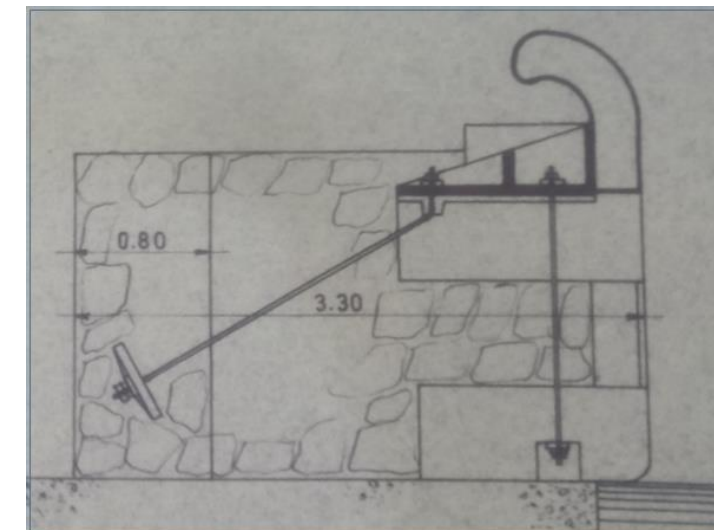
Detalle constructivo de empotramiento de los bolardos en la viga cantil.
